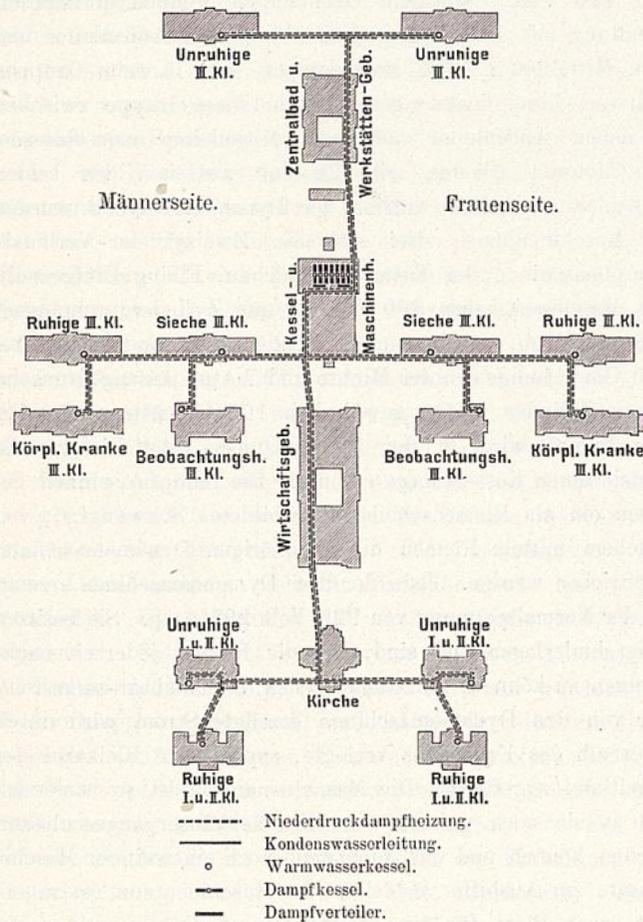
Lageplan der Zentralheizungsanlage mit den unterirdischen Rohrsträngen. 1:3750.
